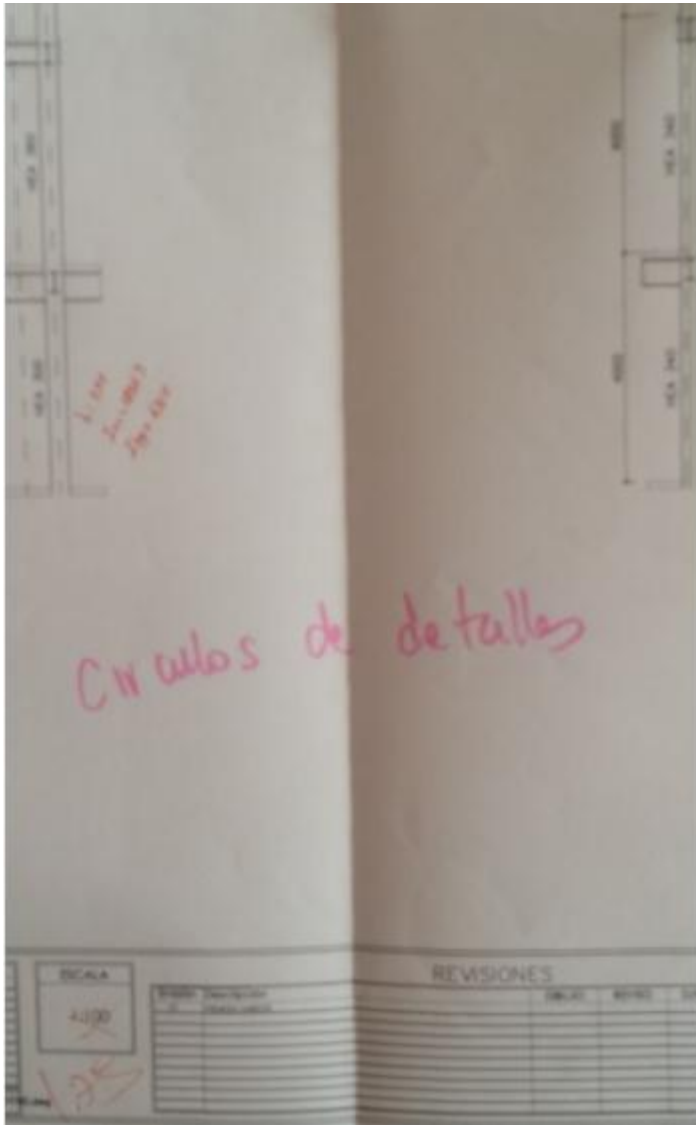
CORRECCIONES REALIZADAS DURANTE EL DIBUJO DE PLANOS ESTRUCTURALES DE ALZADOS Y PORTICOS
